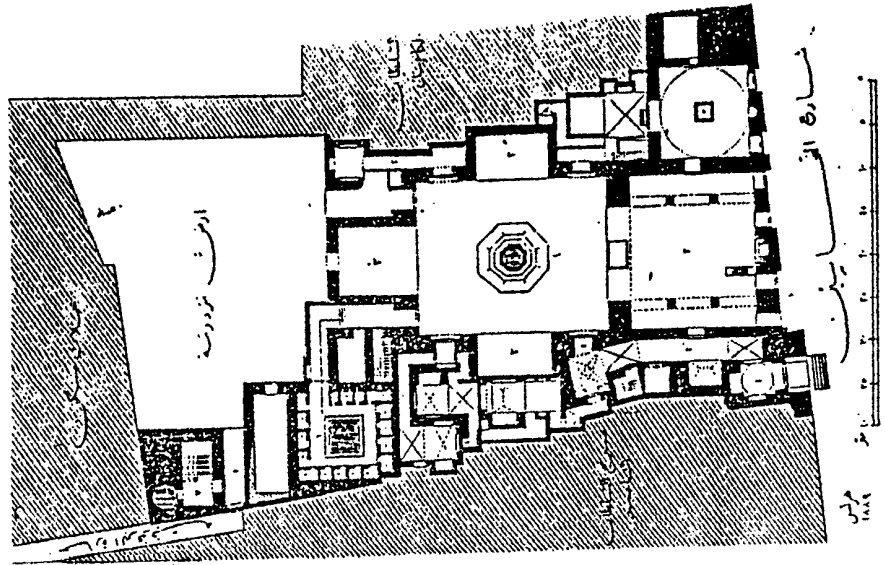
مسقط أفقي لمدرسة السلطان حسن بالقاهرة
